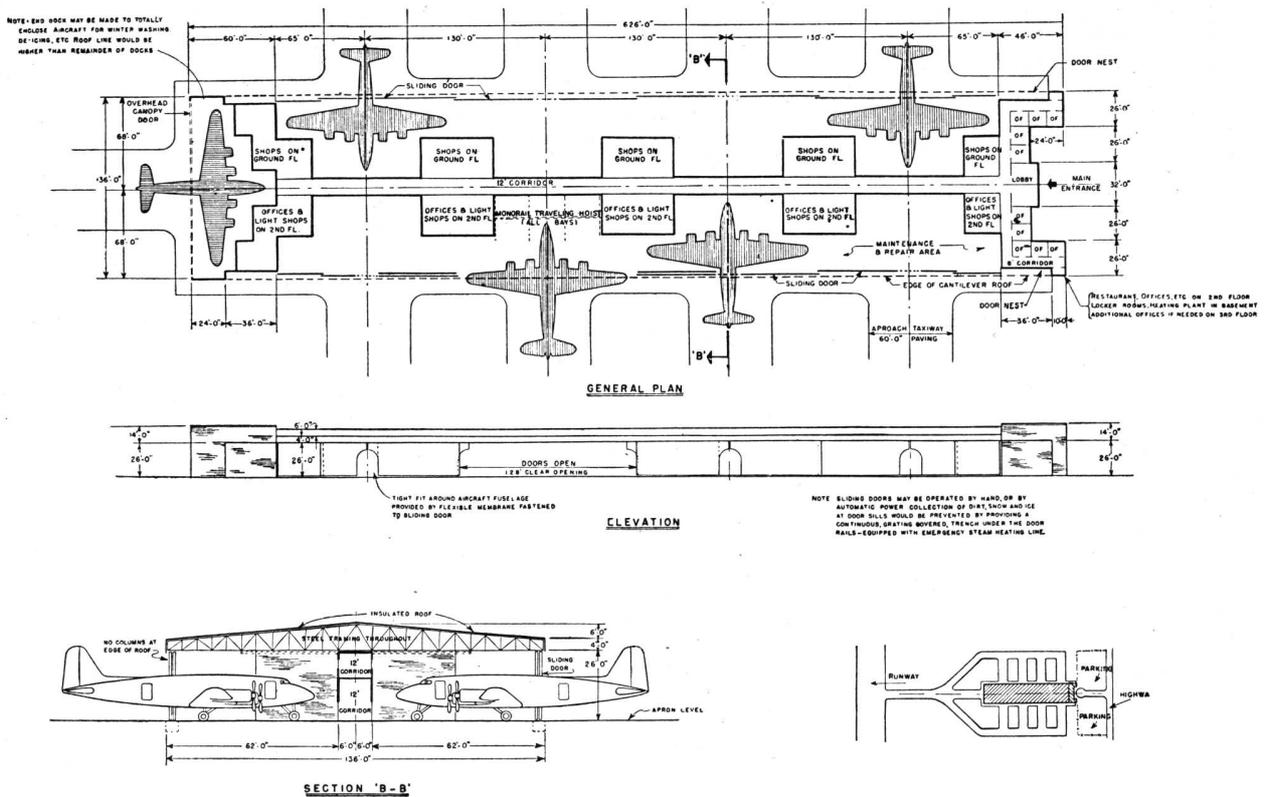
Planta, corte y elevación de un hangar-nariz (tomado del libro "Airport Planning" de Froesch y Prokosch).
